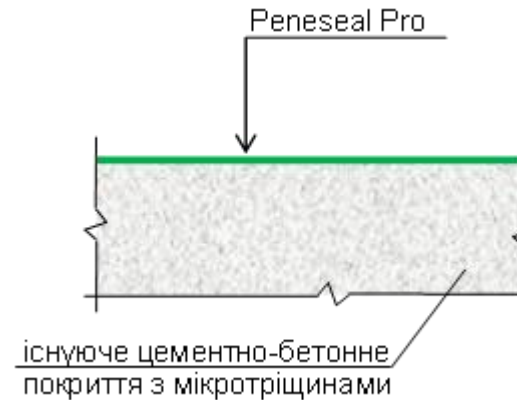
Конструктивна схема зміцнення цементобетонного покриття з мікротріщинами
